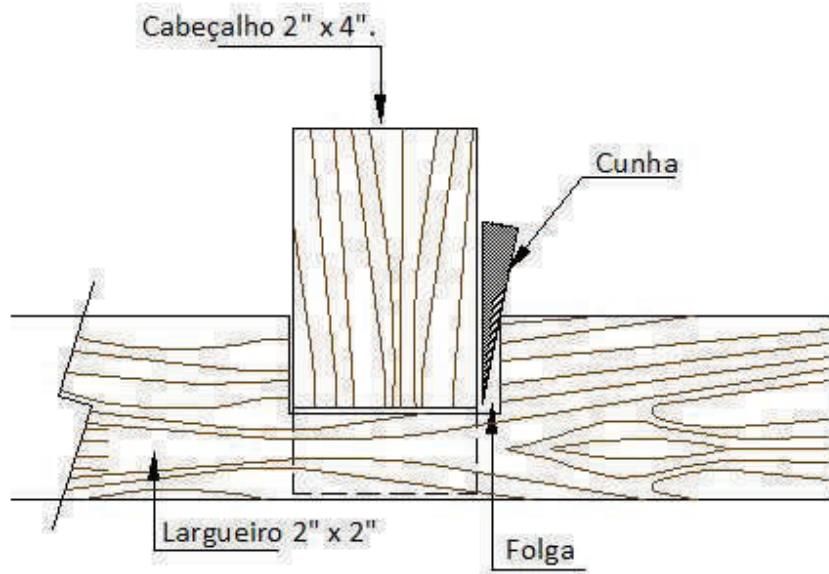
Detalhe de ajuste do cabeçalho com o largueiro. Corte longitudinal. (*-5).
